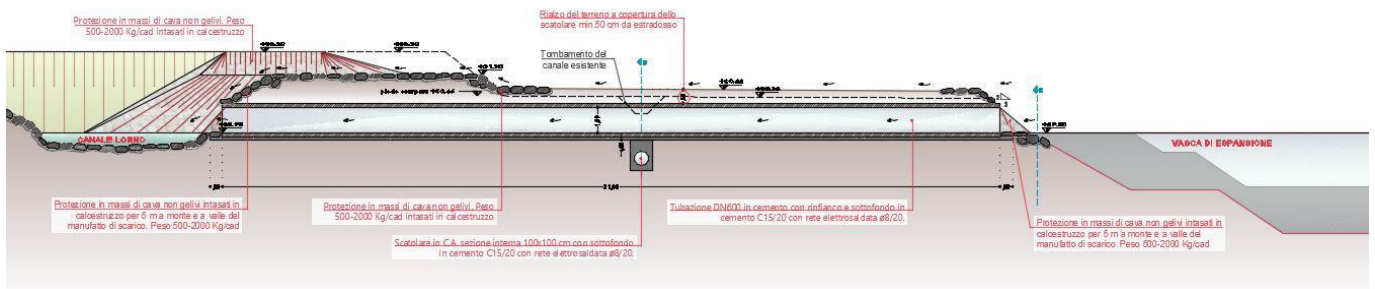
Manufatto di scarico canale Lorno: sezione.
